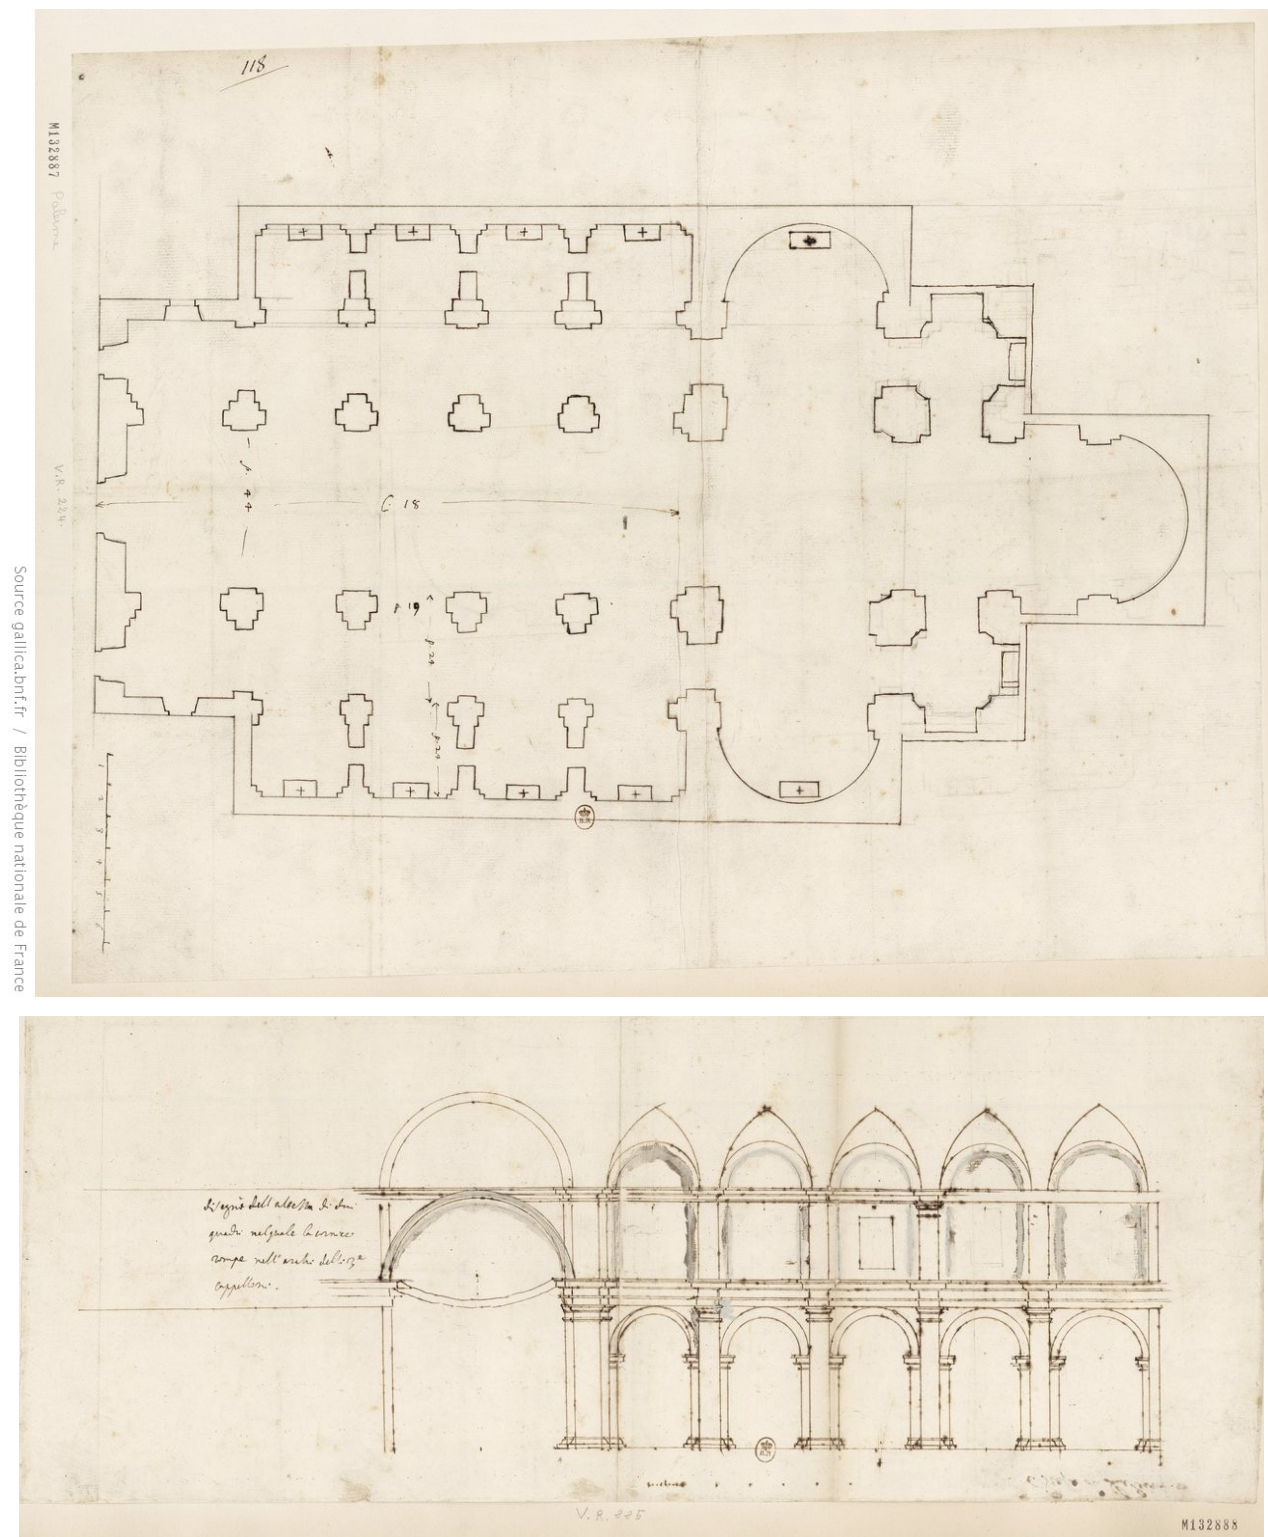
; Natale Masuccio, pianta (a) e sezione (b) della chiesa di Casa Professa di Palermo.
